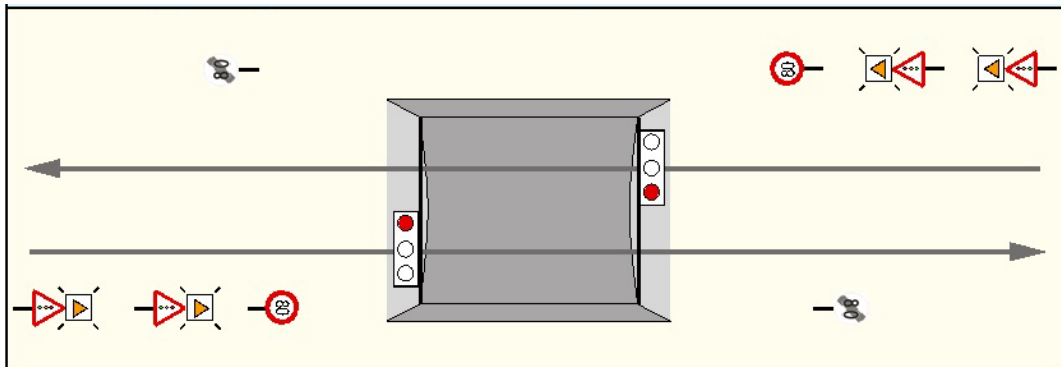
Plan de feux – Fermeture du tunnel dans les deux directions.
